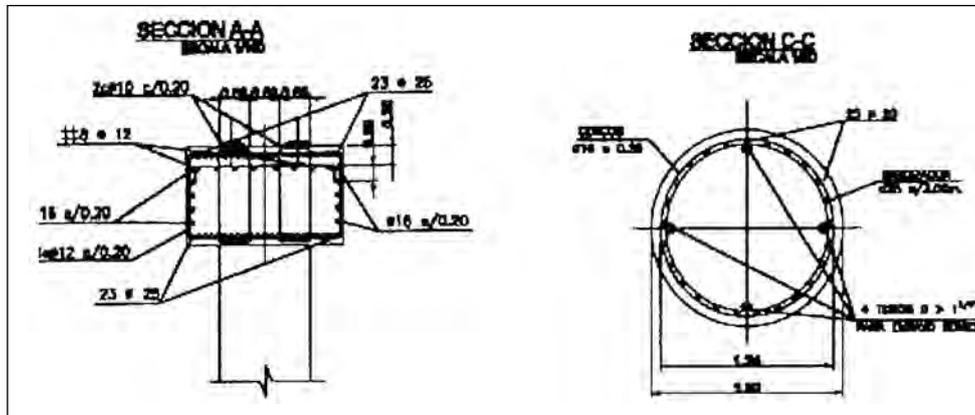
Detalle armado dintel y pilotes de pila y estribo derecho.
